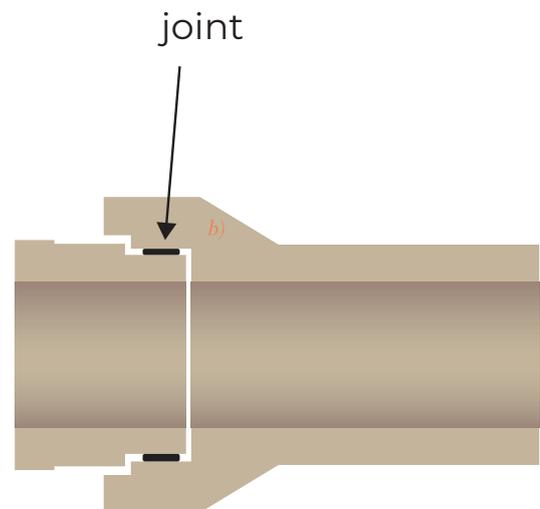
Principe d'assemblage des tuyaux en béton (A écoulement libre) béton
